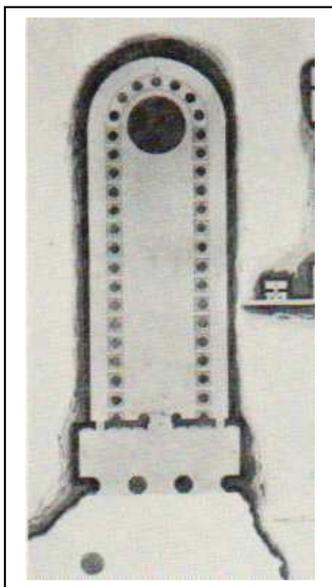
Grundriss, ARCHER, no. 143
